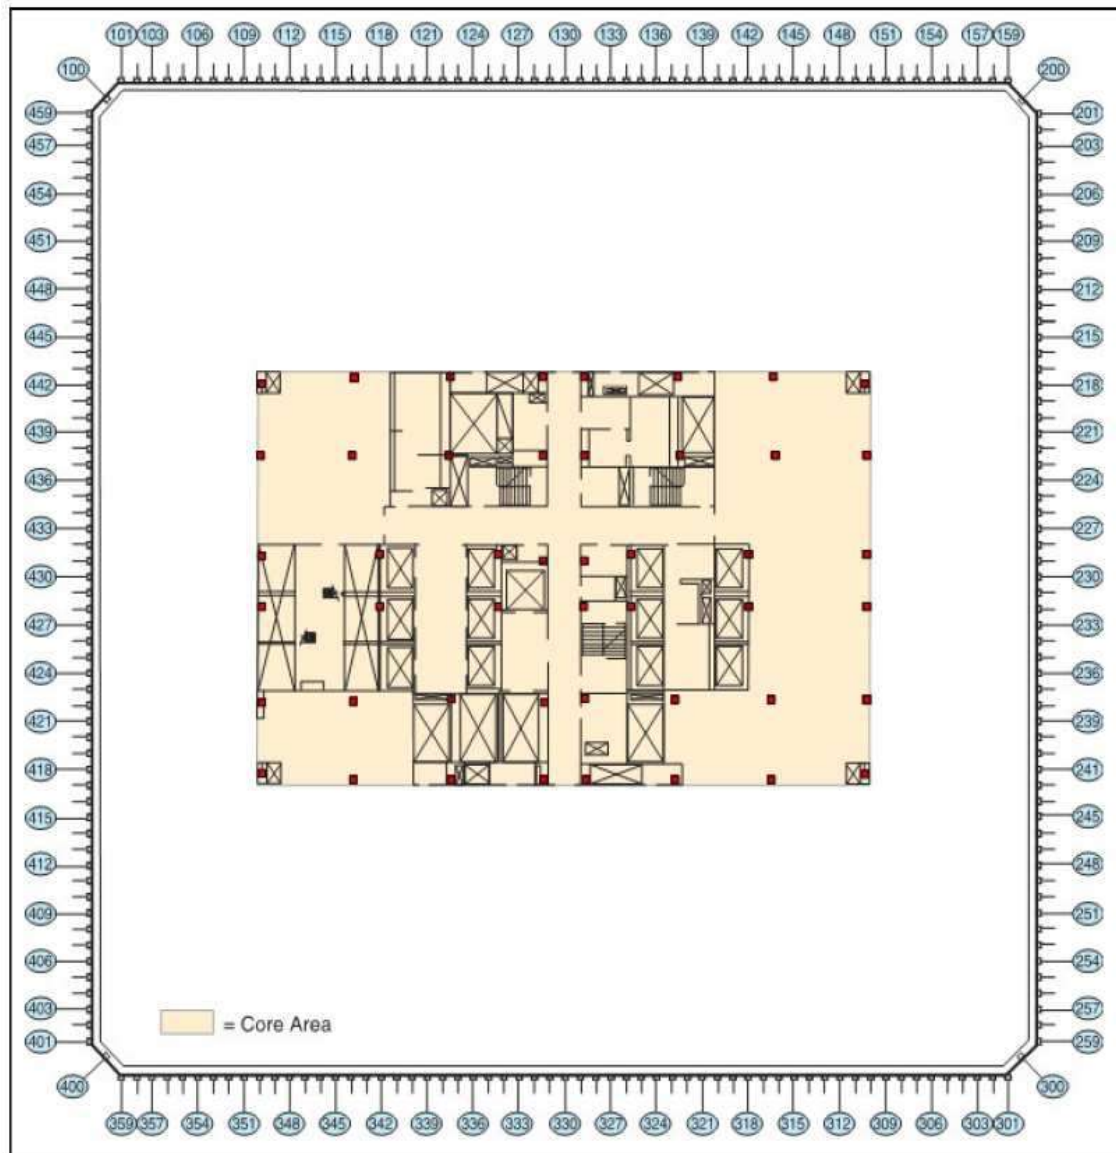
schema di un piano tipo, basato sul piano 94 della Torre Nord.
